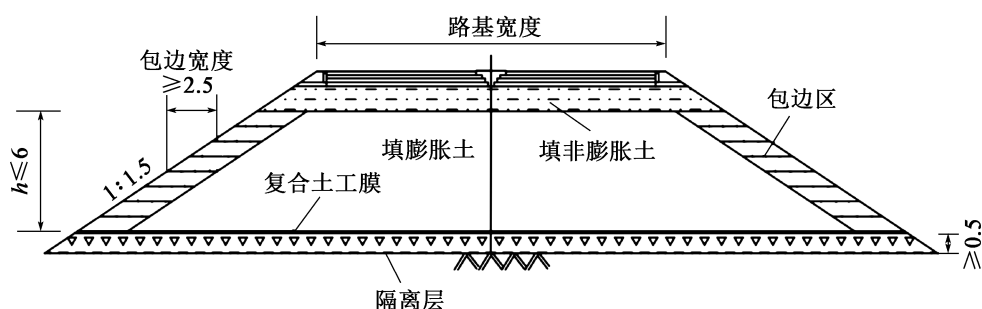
填方路基包边加筋断面示意图 (尺寸单位: m)
